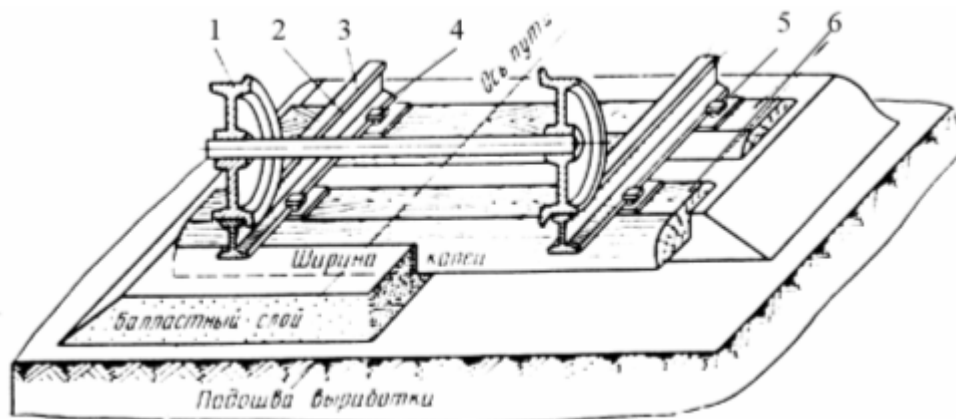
Устройство рельсового пути: 1 – реборда колеса; 2 – рельс; 3 – рабочий кант рельса; 4 – костыль; 5 – подкладка; 6 – шпалы.
